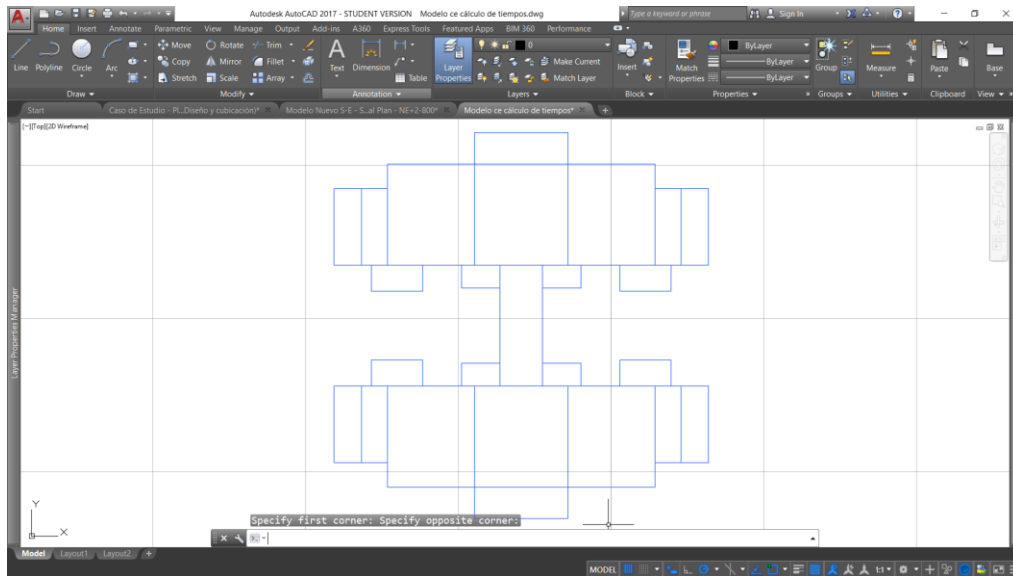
Ejes de los elementos del sistema estructural propuesto dibujados en AutoCAD.
